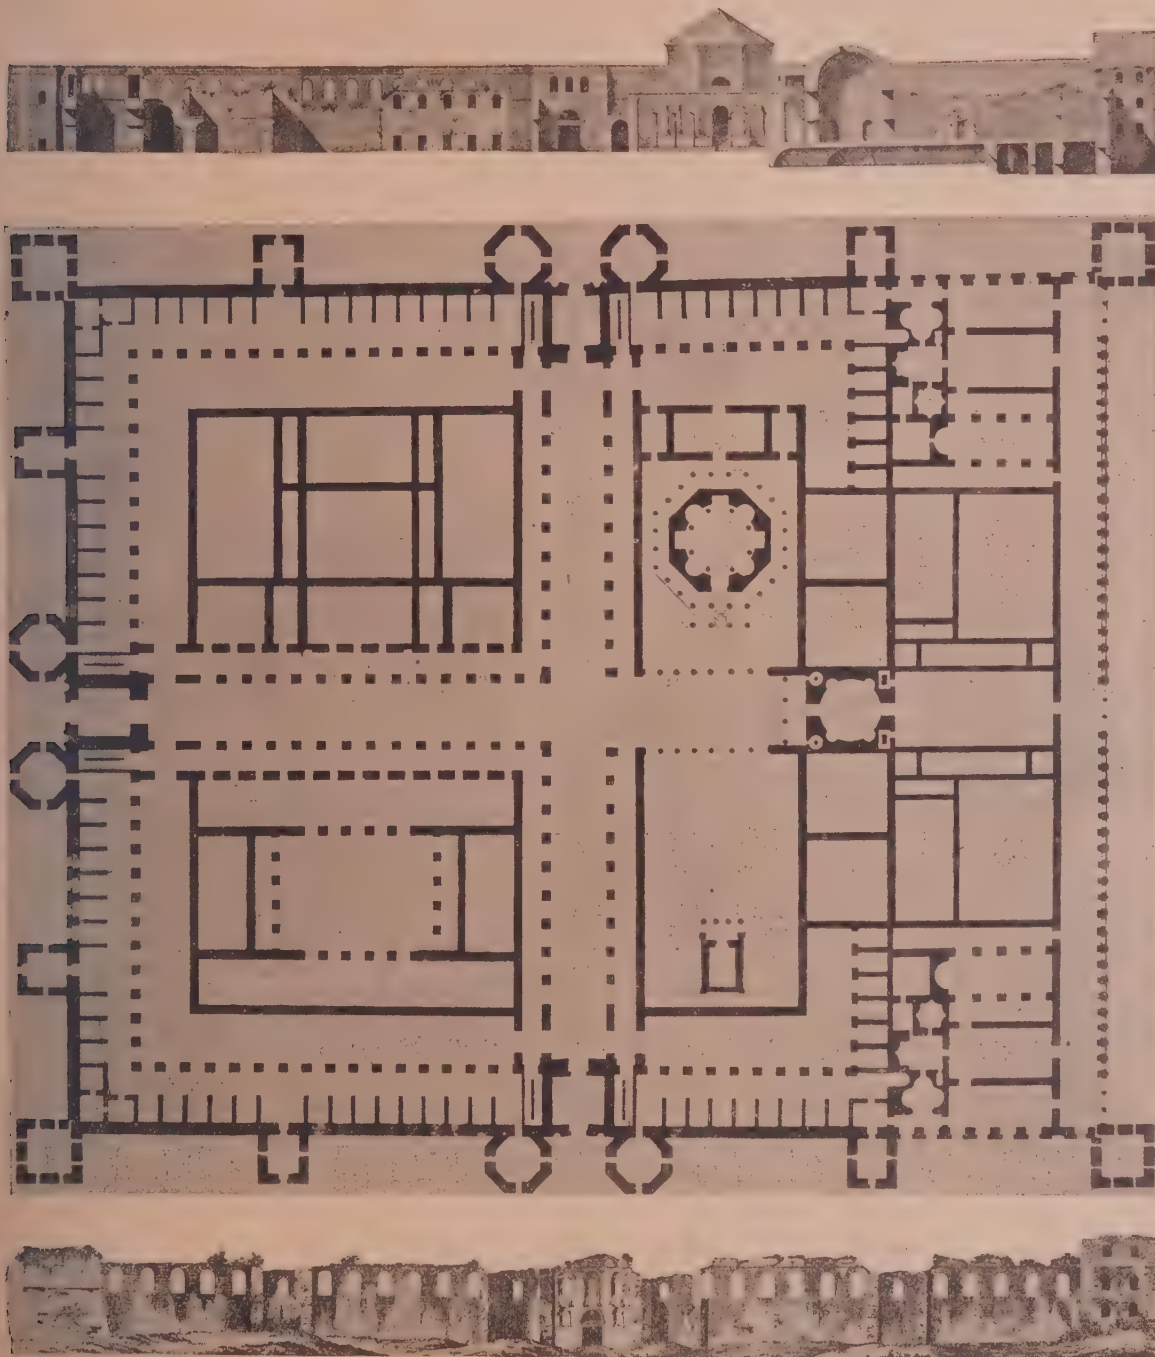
Diokletians-Palast (Spalato), Längsschnitt, Grundriß und Aufbau der Nordfront
